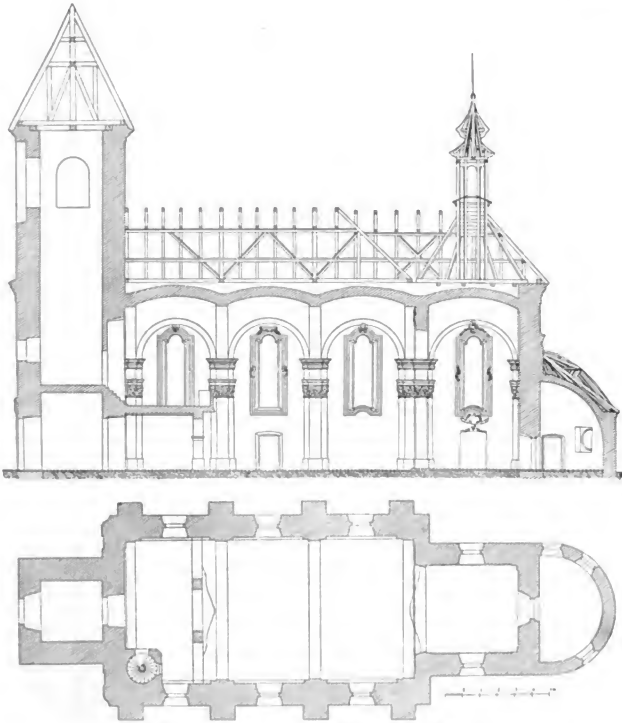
Lužec. Längenschnitt und Grundriss der Kirche.
